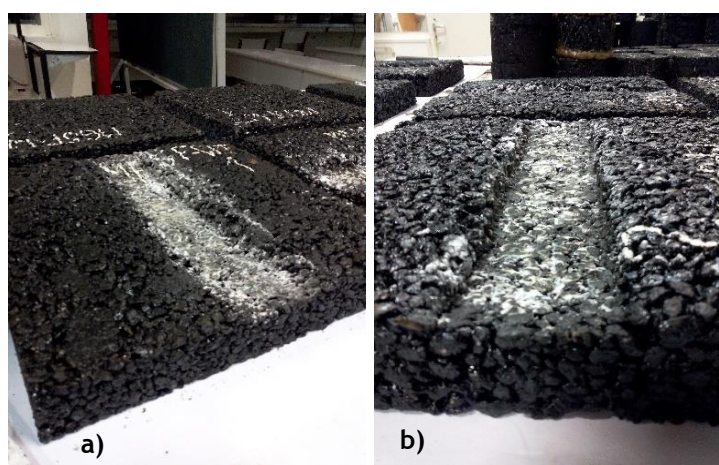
a) Lajeta após ser retirada da máquina de ensaio; b) Pormenor do cavado de rodeira.
